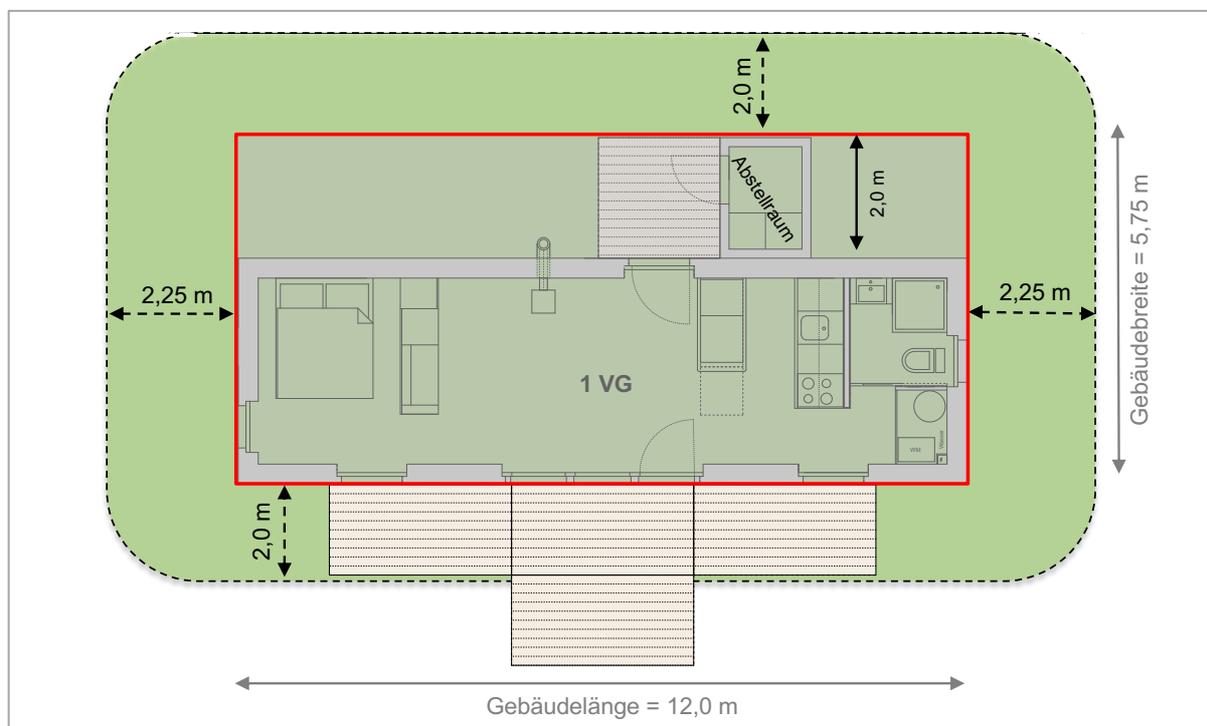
Grenz- und Gebäudeabstand des einstöckigen Tiny House-Prototyps: der rote Rahmen um fasst die Wohnfläche des Tiny Houses. Die Gebäudelänge beträgt 12,0 m und die Gebäudebreite beträgt 5,75 m. Die grüne Fläche kennzeichnet hierbei den mindestens einzuhaltenen Grenzabstand (Quelle: in Anlehnung an: Ökominihaus, o.J.b).
